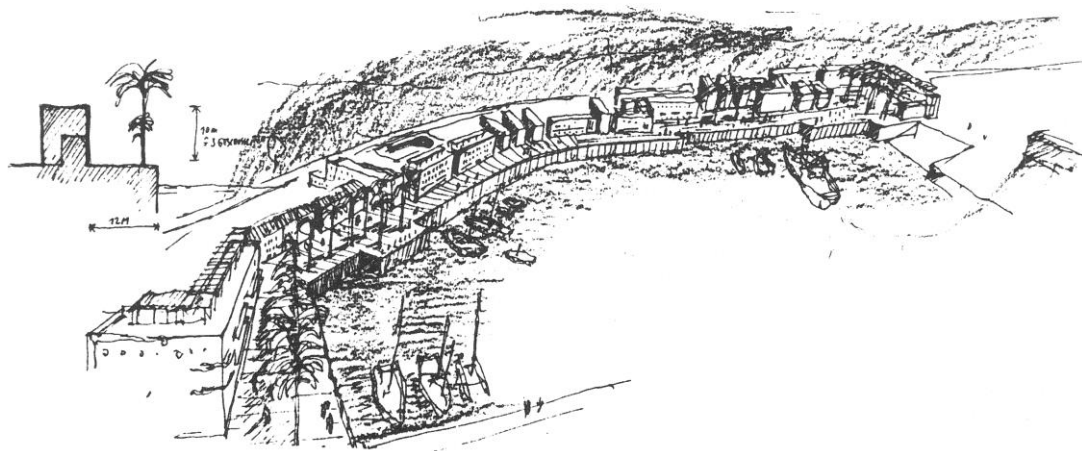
Proposta de edificação junto ao Porto de Abrigo.
